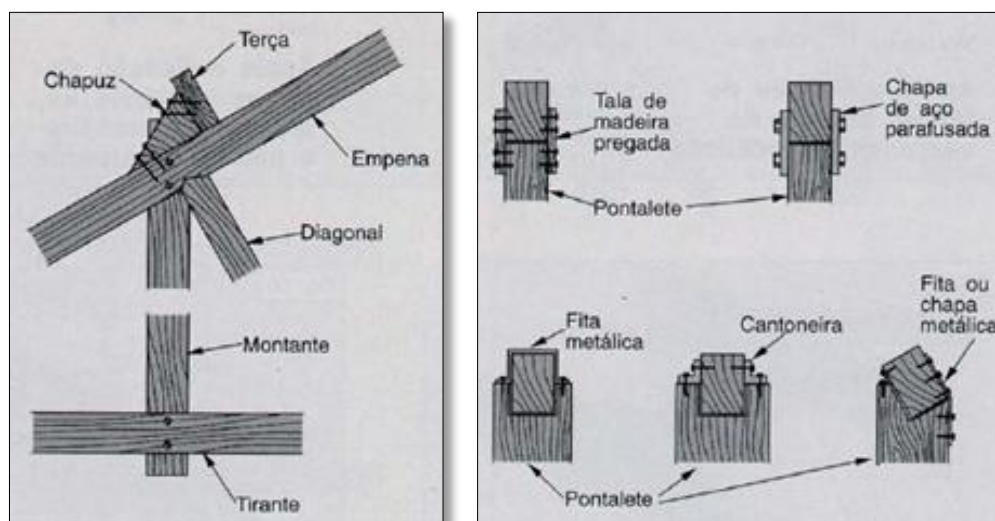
Apoio e fixação de terça na empena por meio de chapuz de madeira.
